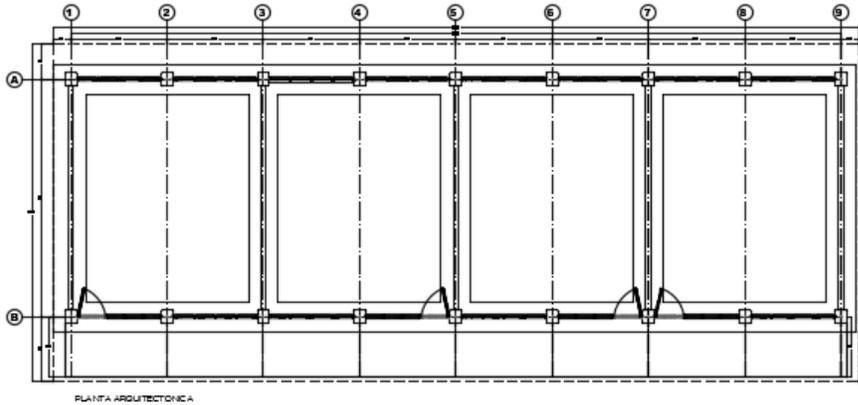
Representación de cimentación en planta arquitectónica. (Educativa I. N., 2015)
